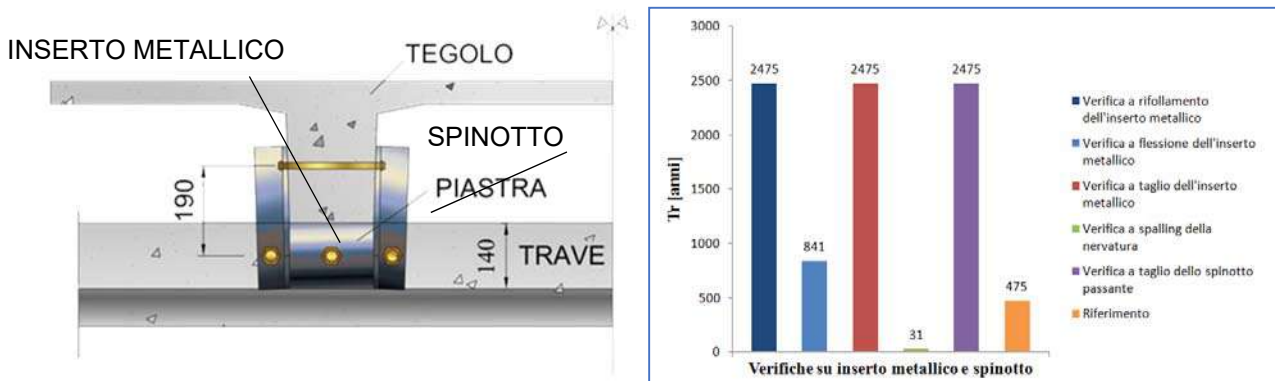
Schema statico del collegamento trave-tegolo (Belletti et al., 2014)
